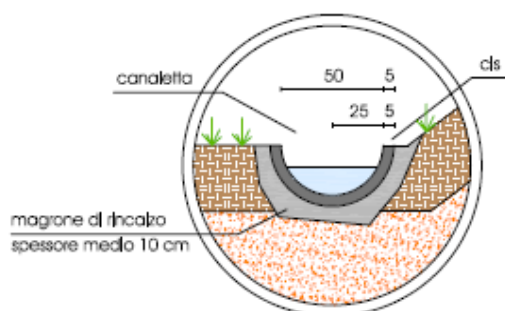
Particolare canaletto di scolo in calcestruzzo
